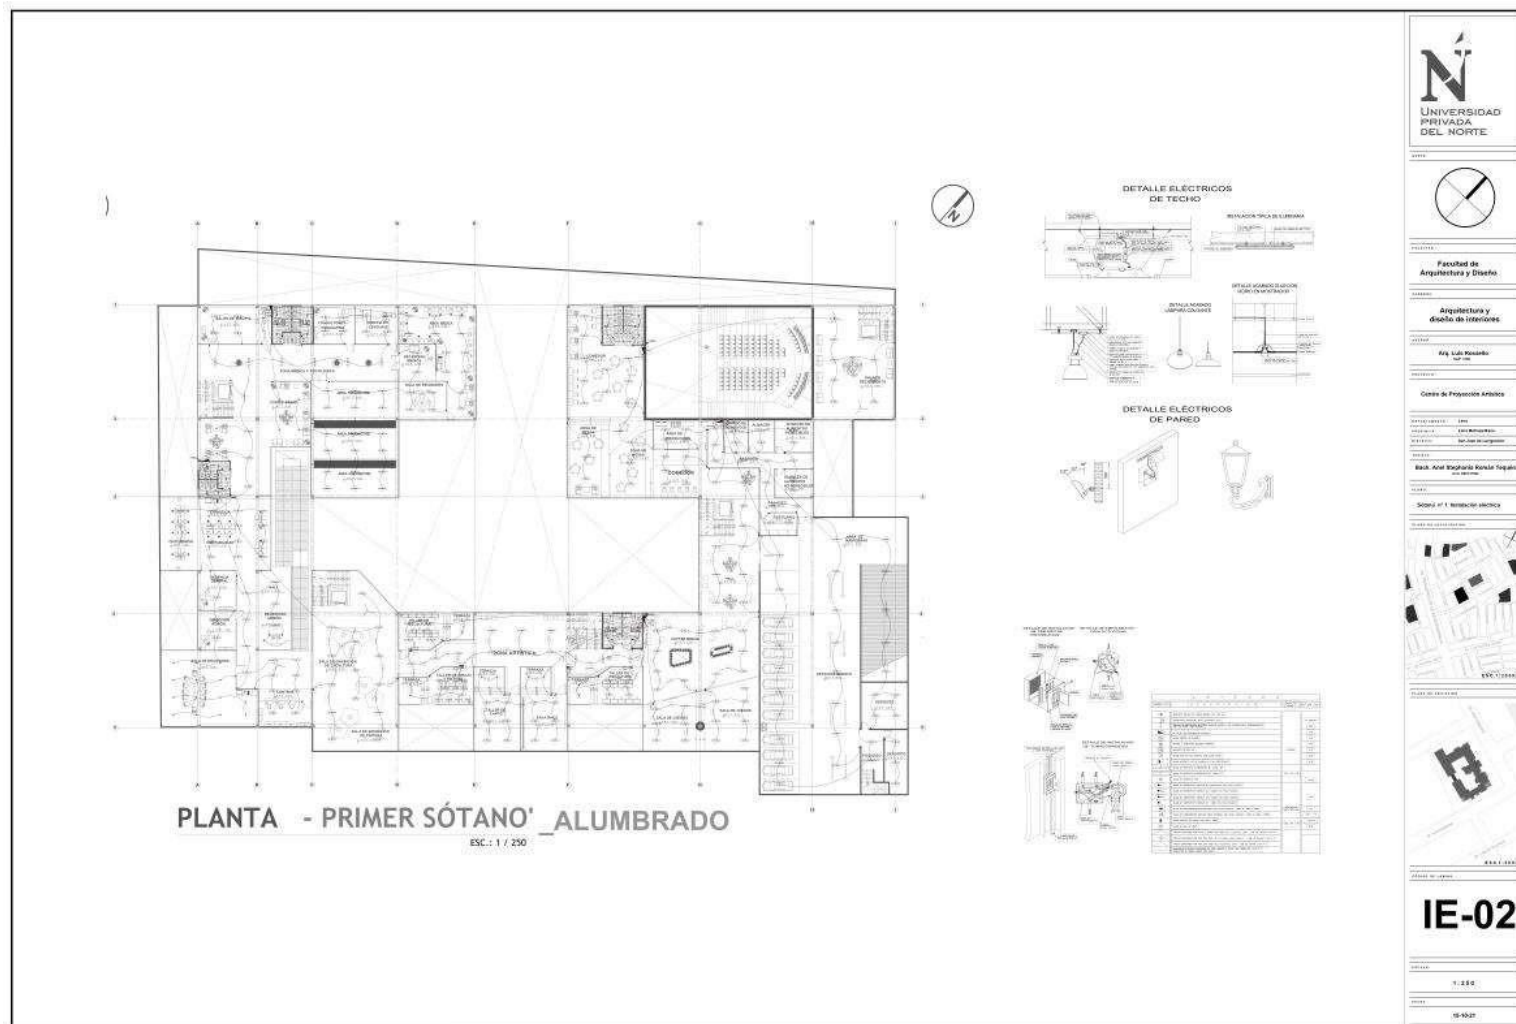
Instalaciones Eléctricas – Sótano 02 – Planta General
